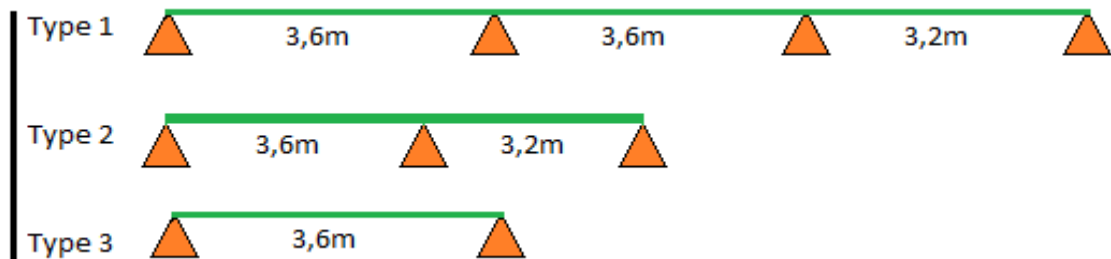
Types de poutrelles dans terrasse inaccessible.
